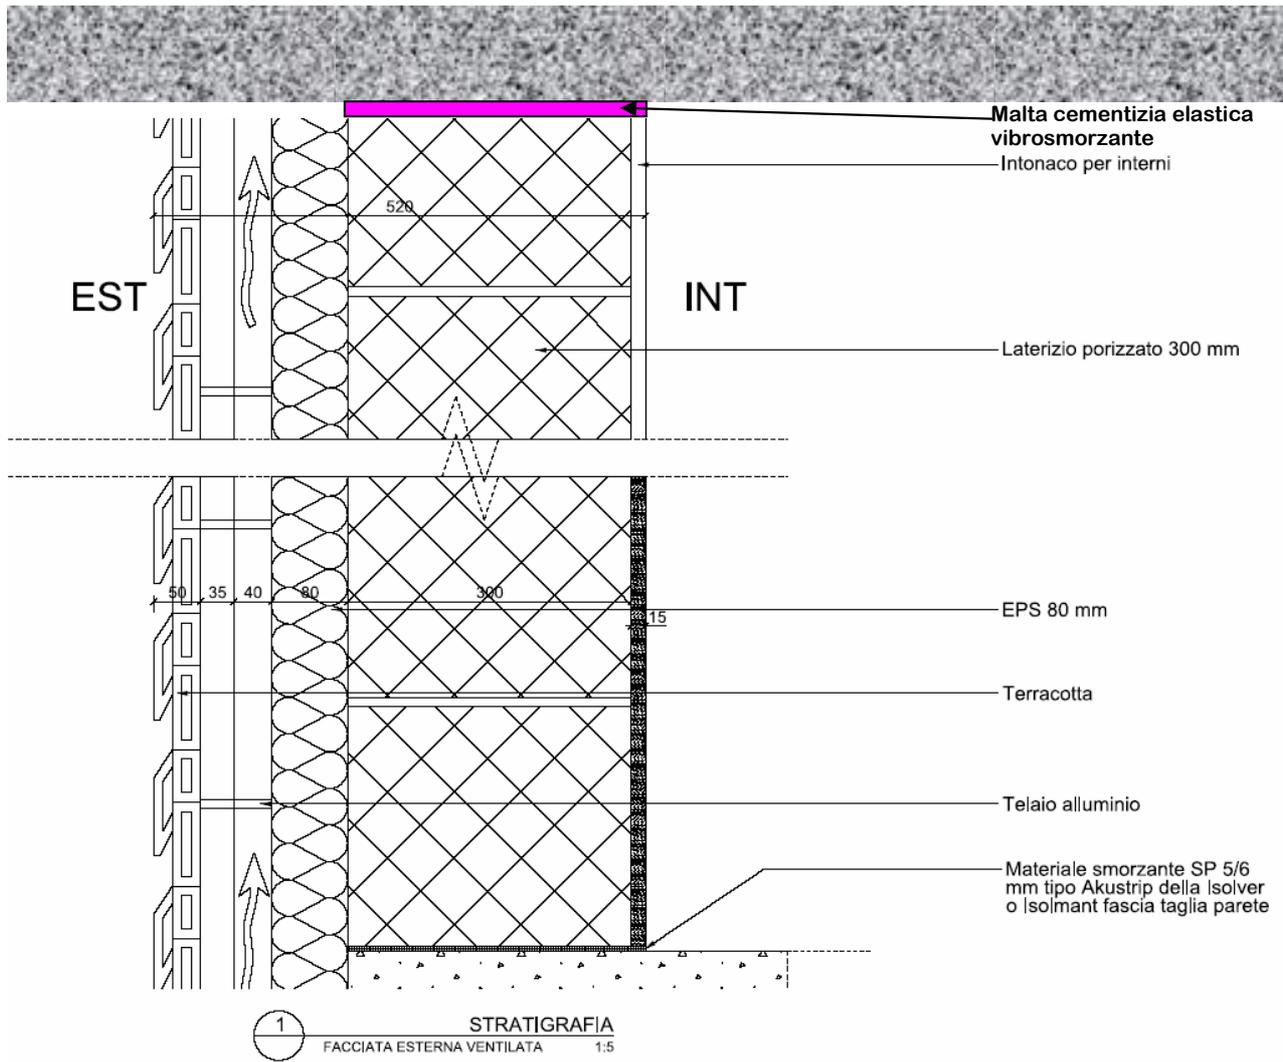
Sezione verticale della parete di facciata esterna ventilata
